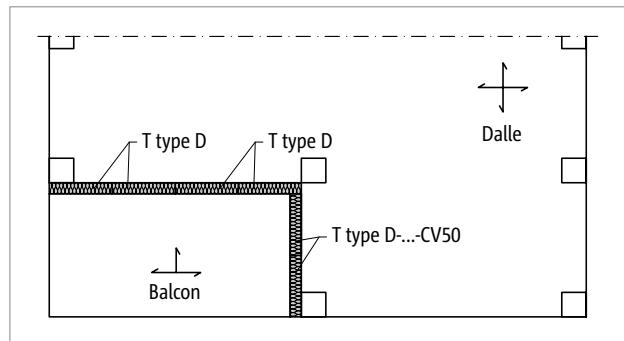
Schöck Isokorb® T Type D : Utilisation dans des planchers plats
